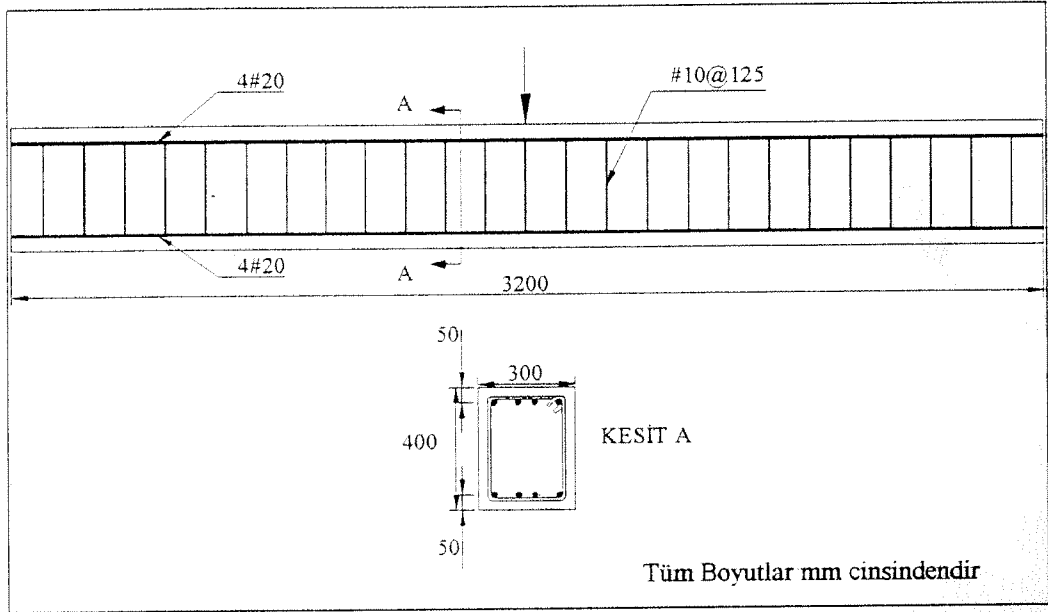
Arayüz elemanı kesme davranışı için kullanılan betonarme kiriş detayları.
